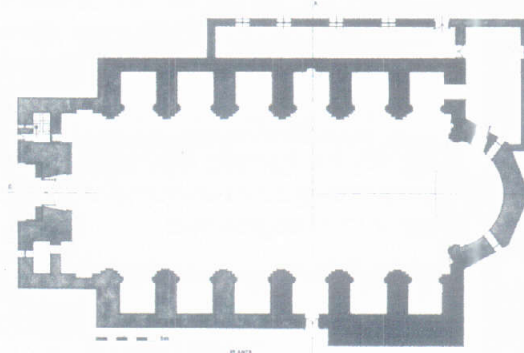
Planta de la iglesia parroquial de Belalcázar.
